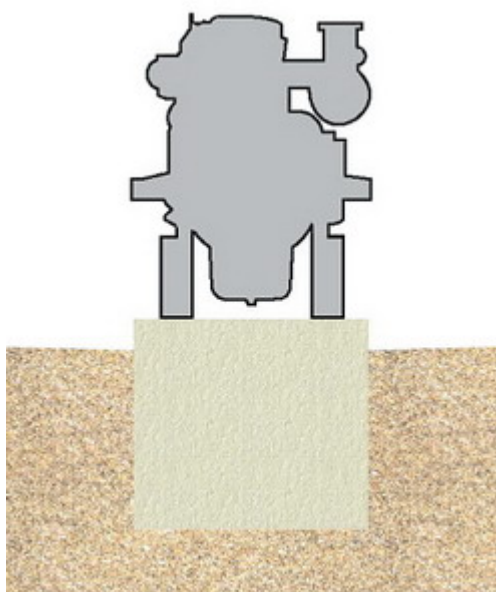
Cimentación sobre tierra, tomado de Grundfos Pump Handbook.
